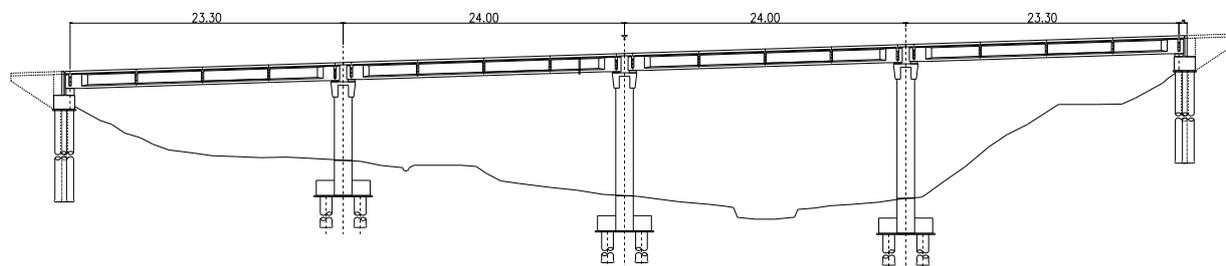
Sezione longitudinale attuale del ponte sul viadotto Zuane (km 202+085)
